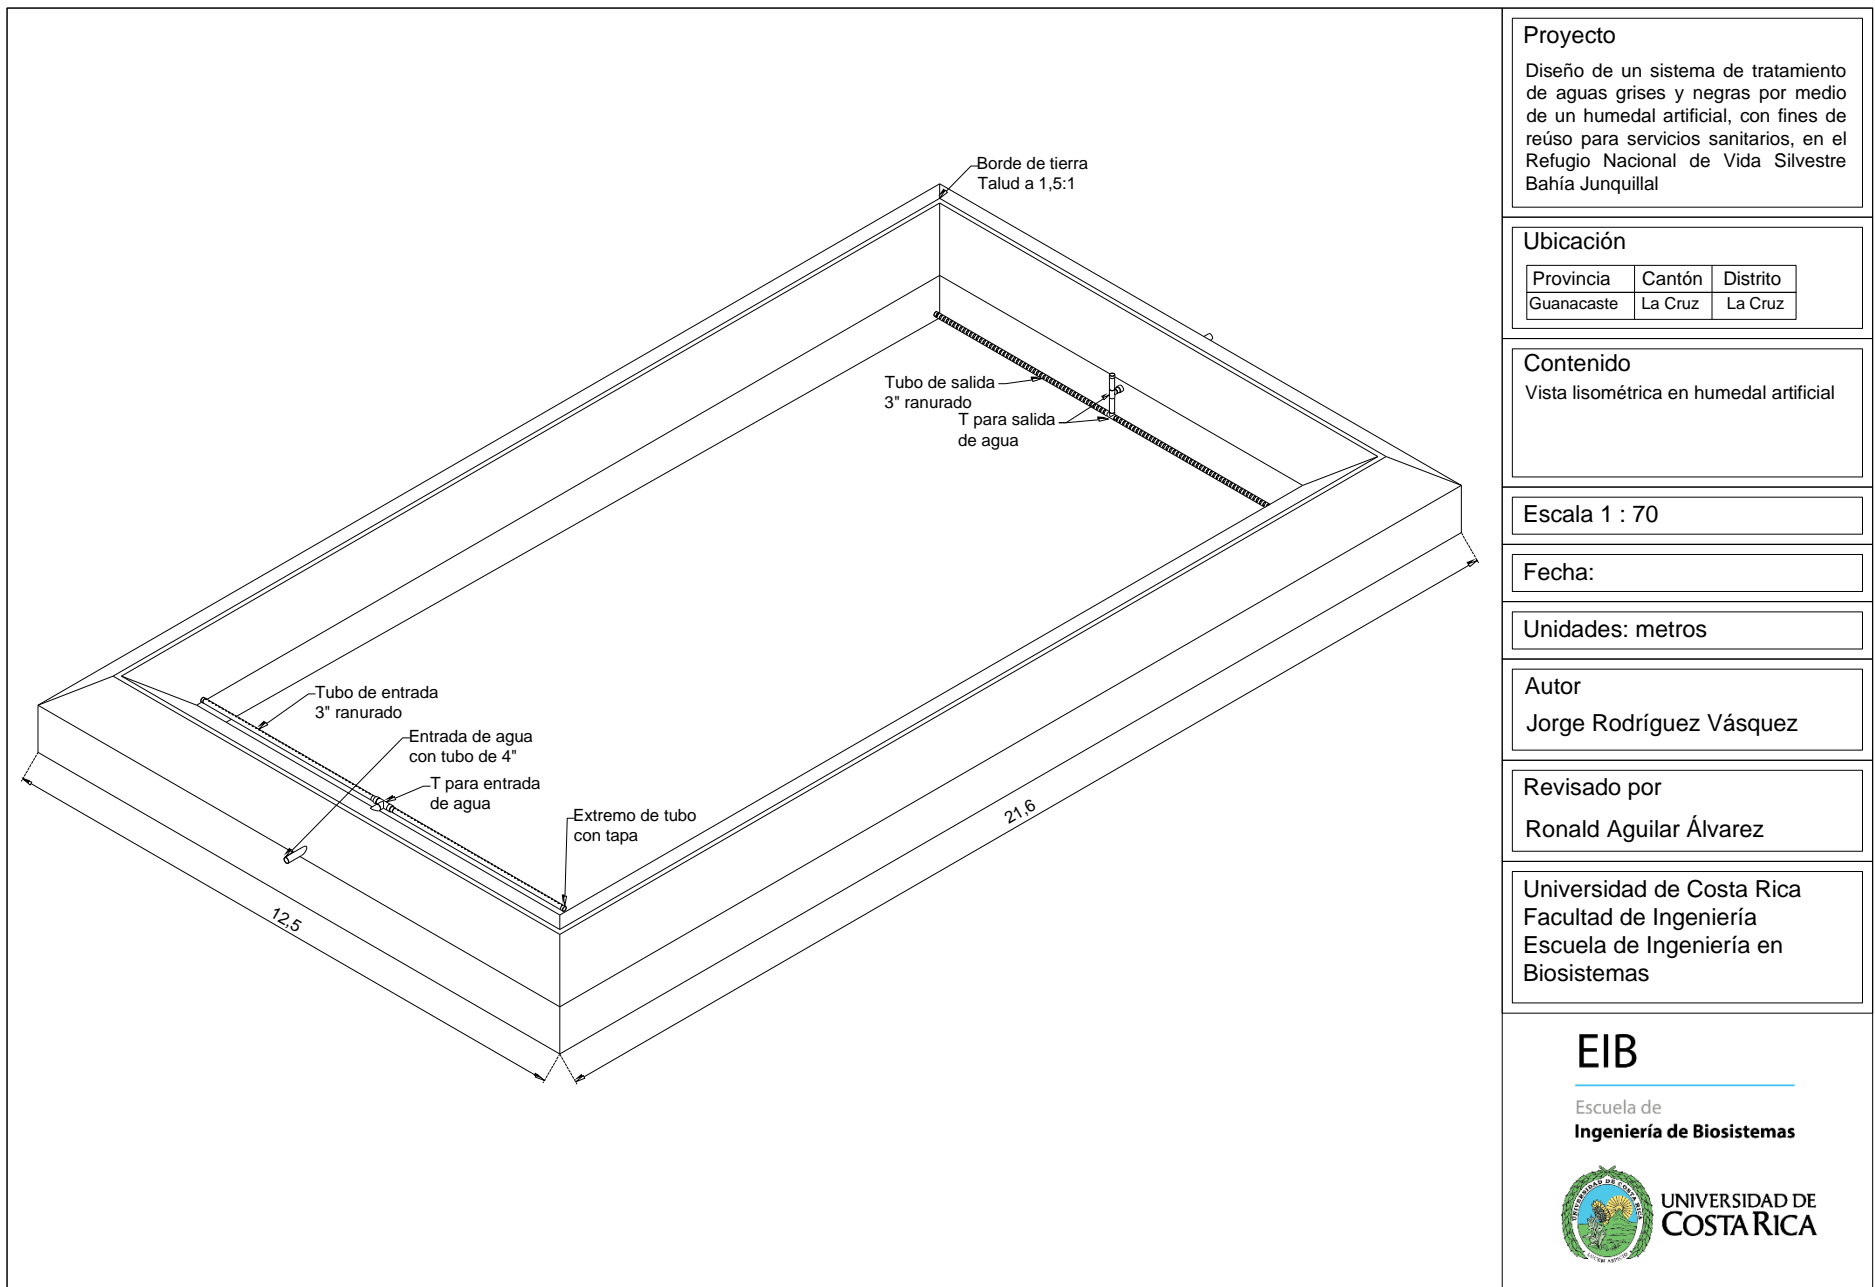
Planos constructivos de vista isométrica de humedal artificial
